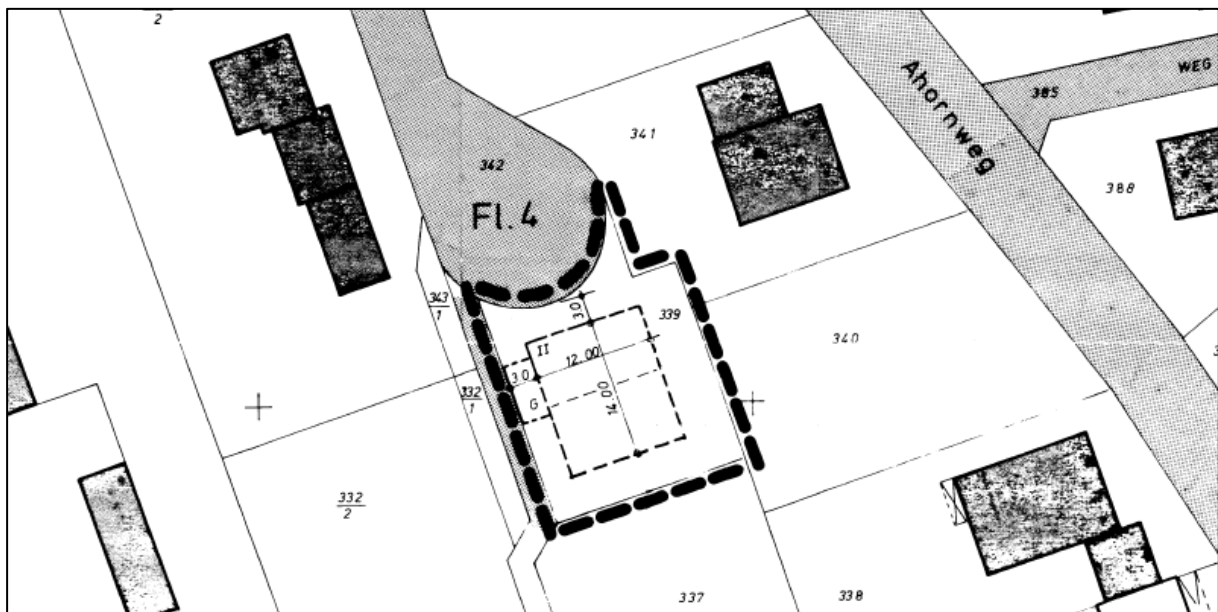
Bebauungsplan Nr. 9c zur Änderung des Bauungsplans Nr. 9b
